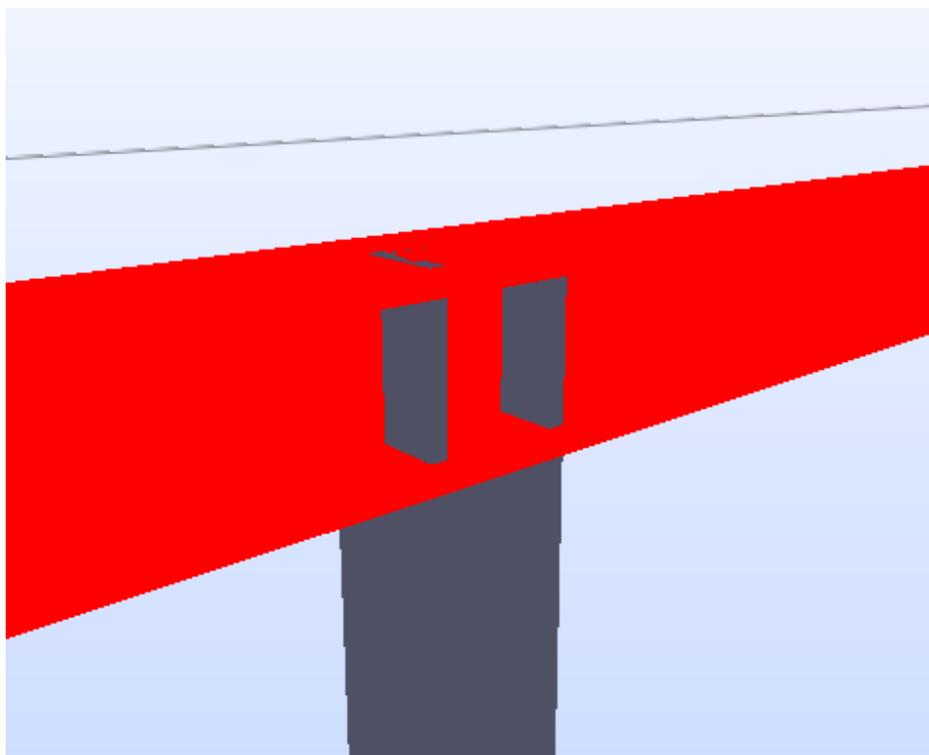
Conflicto de pilar superpuesto a viga. Fuente Propia
